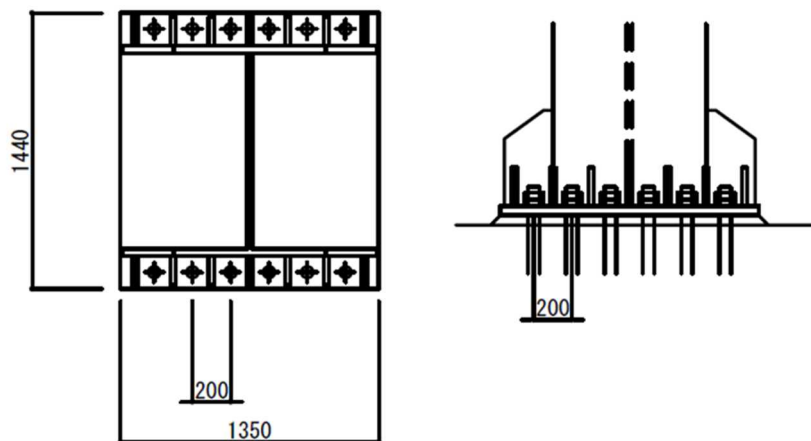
(8) 柱脚部断面图 (单位：mm)
